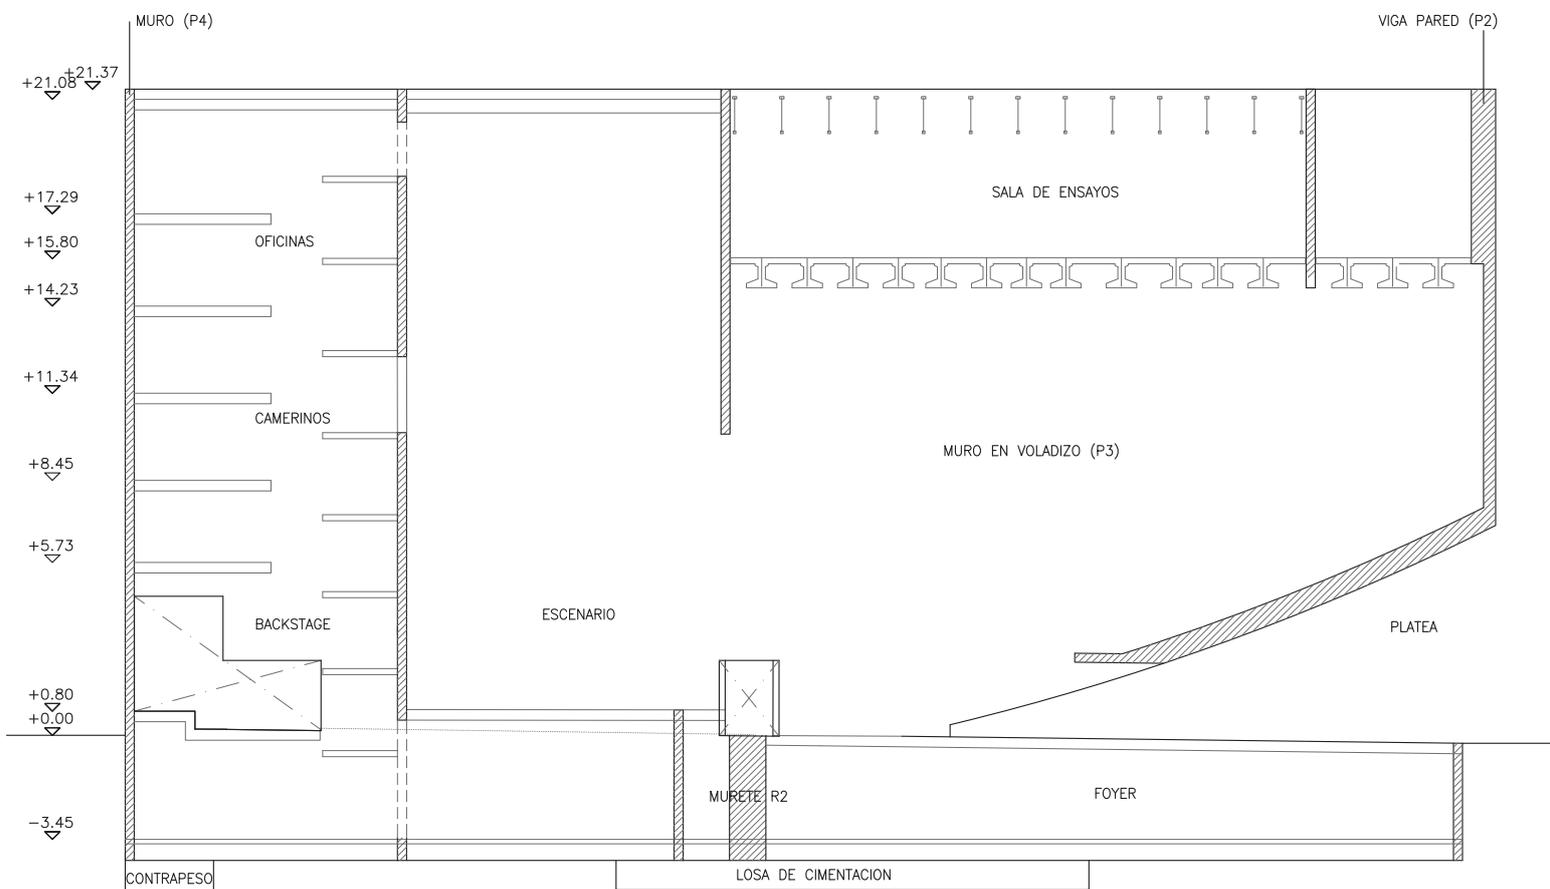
Sección 1, Alzado del muro P1, E:250 [27]
